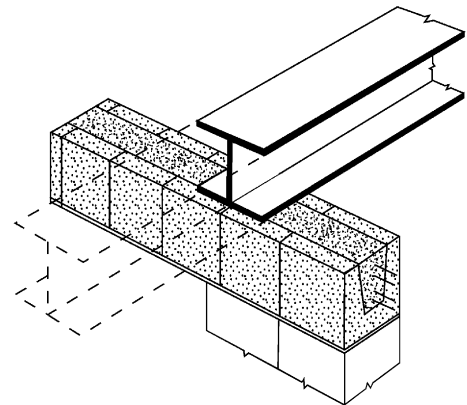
Apoyo de cargas puntuales. Sobre macizados de hormigón.
